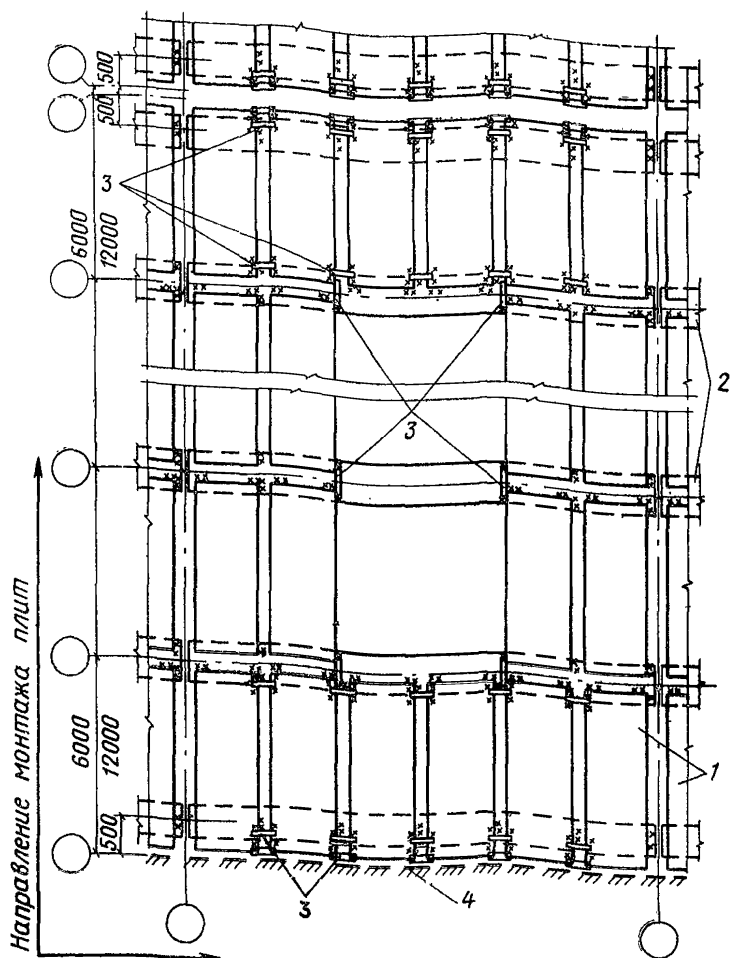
Приварка плит к стропильным конструкциям и соединение плит между собой стальными накладками в покрытиях с фонарем при расчетной сейсмичности здания 8 баллов
